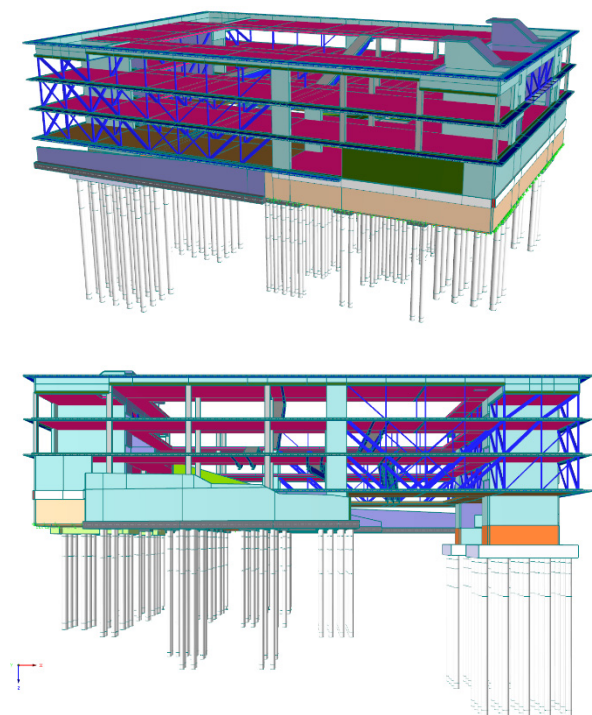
Vistas del modelo de cálculo del edificio. Fachadas Este y Oeste.
